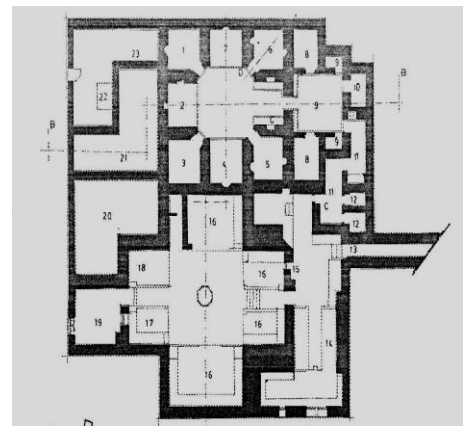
مسقط أفقي للتخطيط الأصلي المقترح
